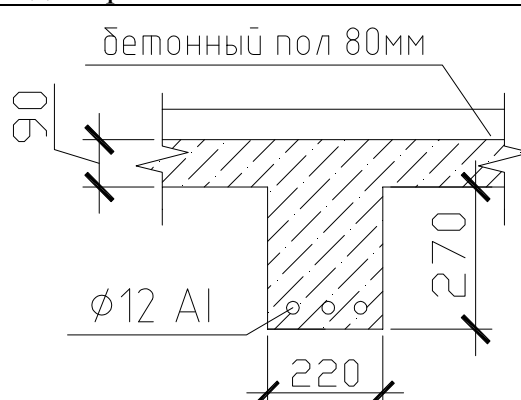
Второстепенная балка ж/б перекрытия над вторым этажом в осях «8-11/Б-В»
